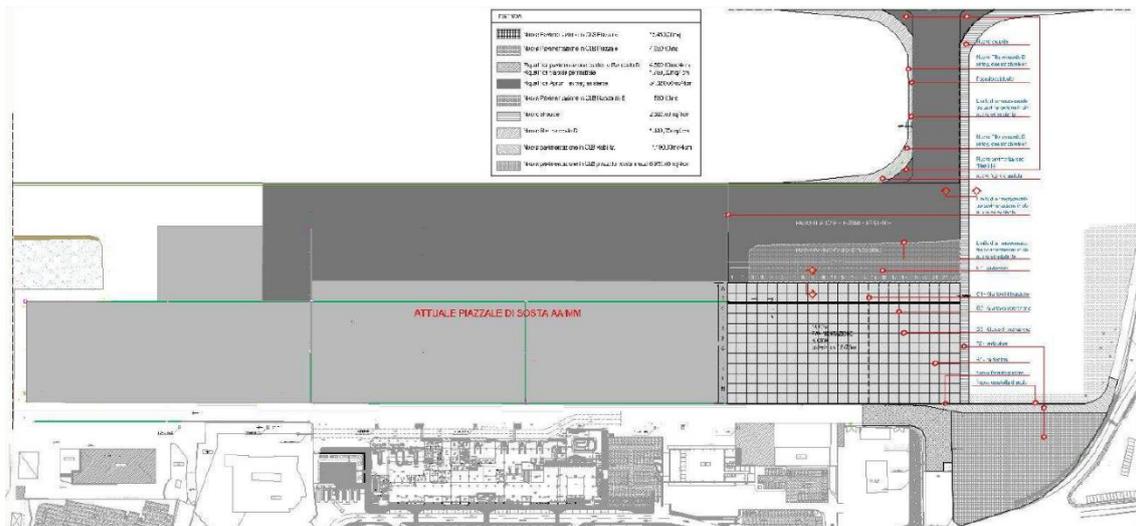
Piazzale di sosta aeromobili Aeroporto di Brindisi – Planimetria stato futuro
